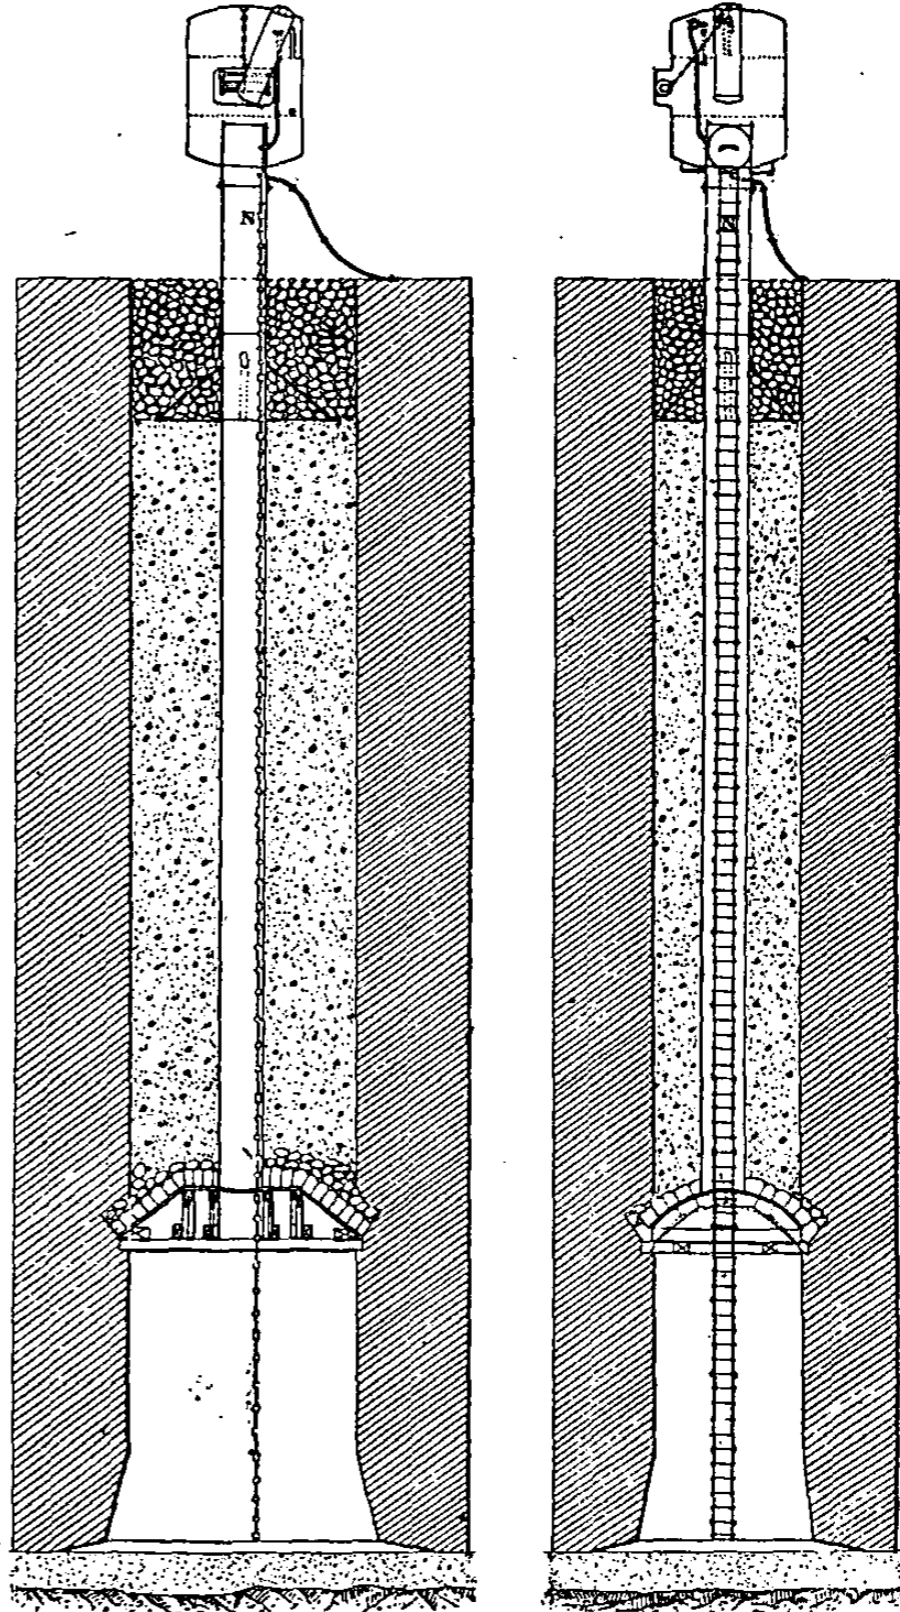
et 529. — Coupe d'une pile de fondation avec caisson de fonçage en maçonnerie.
